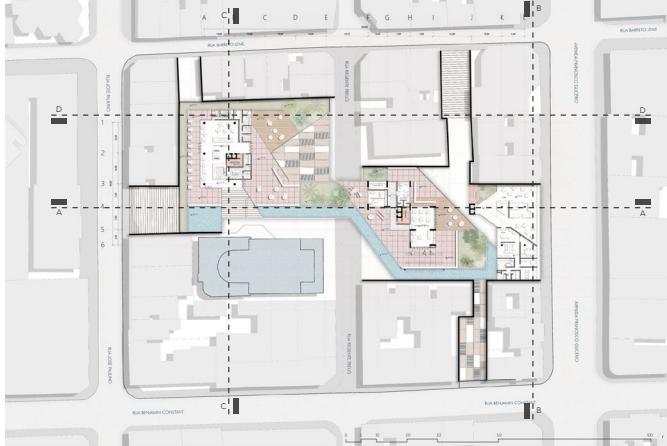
Planta do térreo suspenso (galeria) / Fonte: Autoria do grupo
